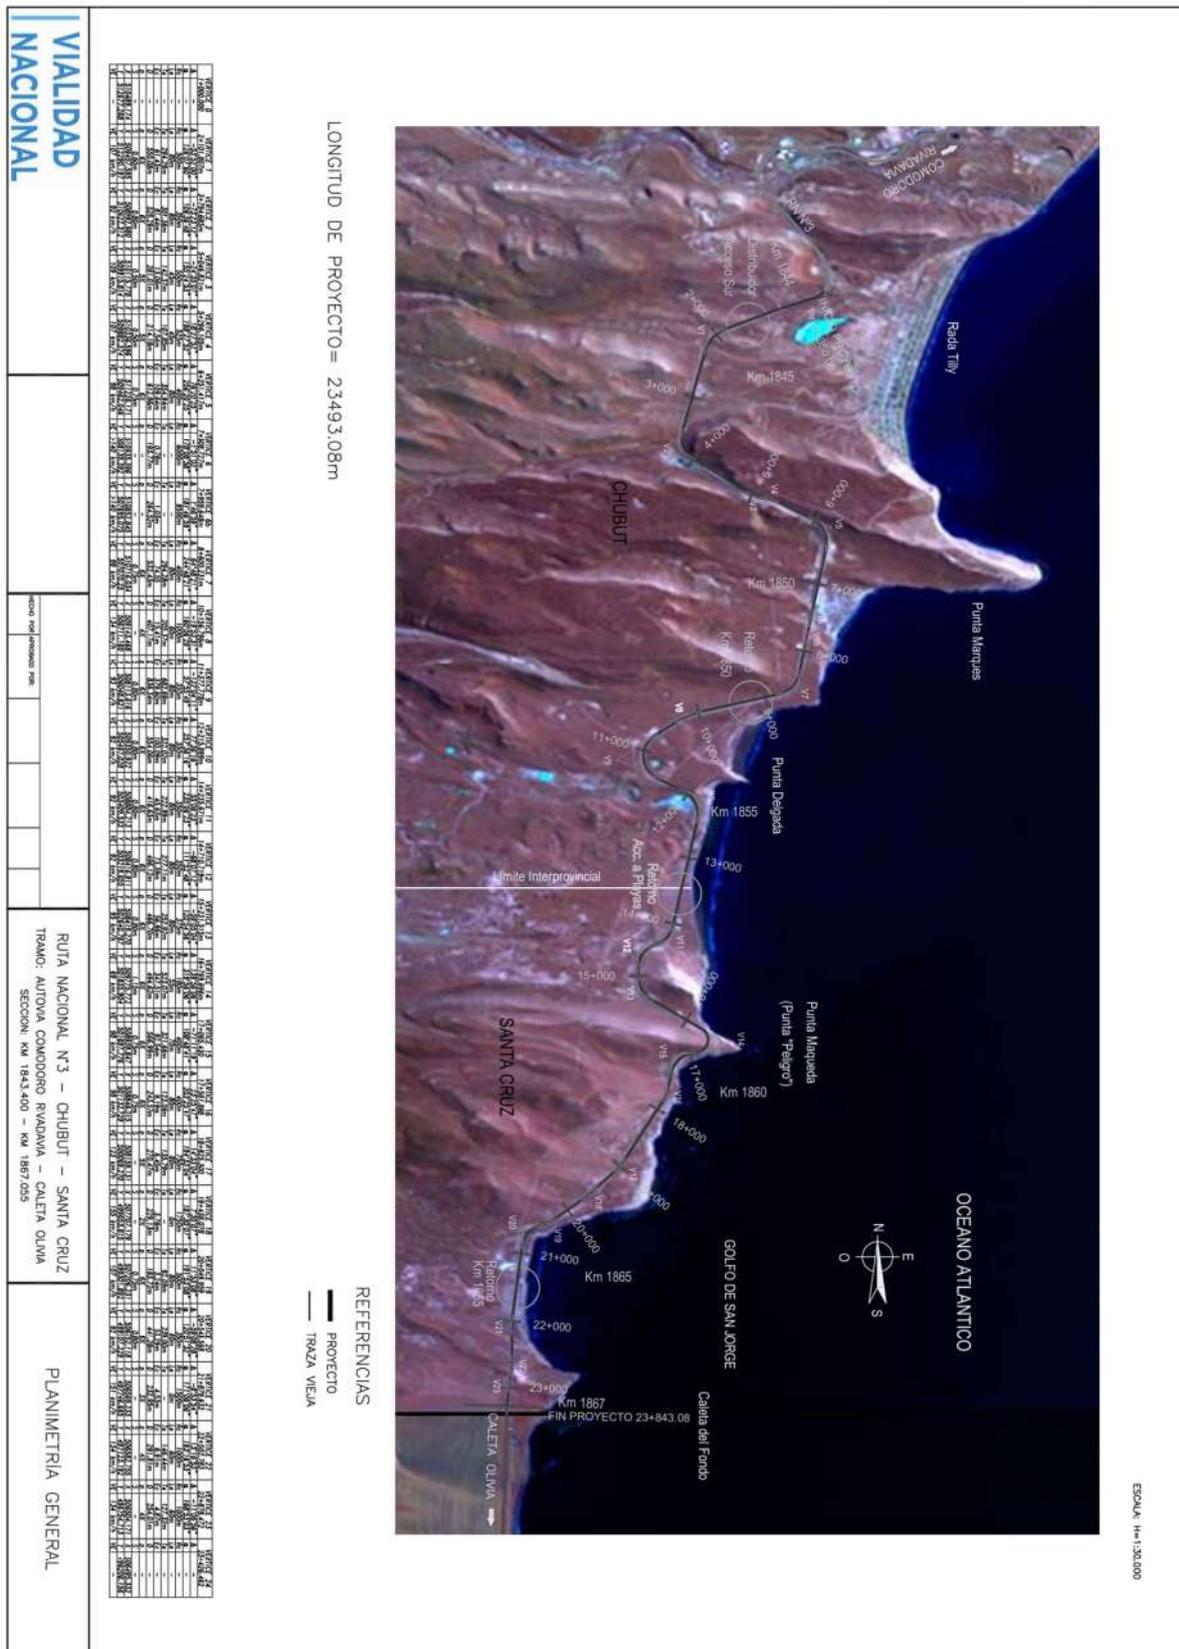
Plano con detalle de la traza para el Proyecto.
